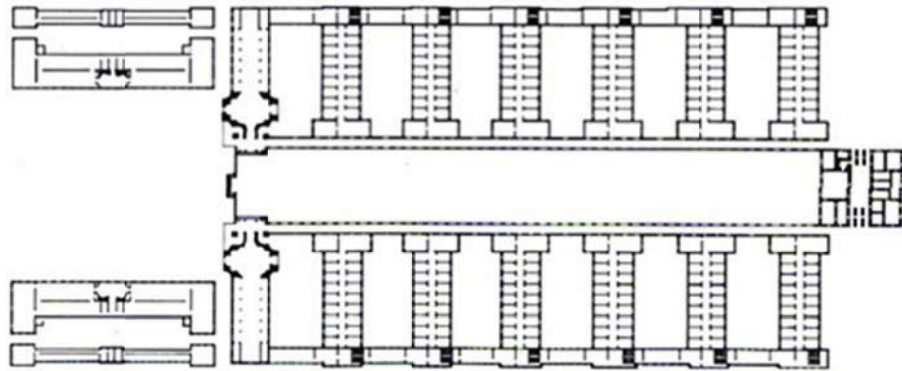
Pianta del progetto per il Royal Naval Hospital, Greenwich-Londra,1694
